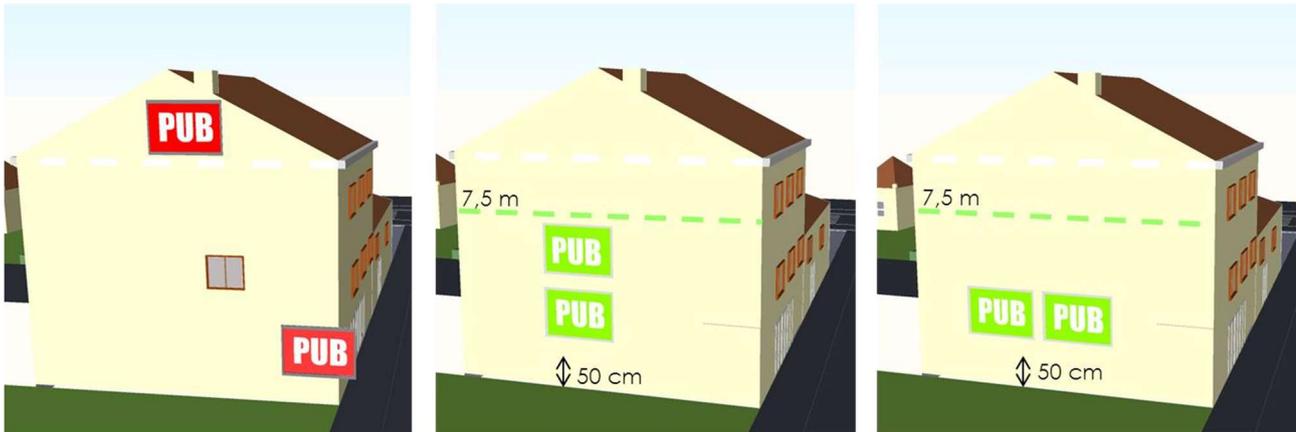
Exemples d'implantations de publicité murale (en rouge : non conforme / en vert : conforme)
